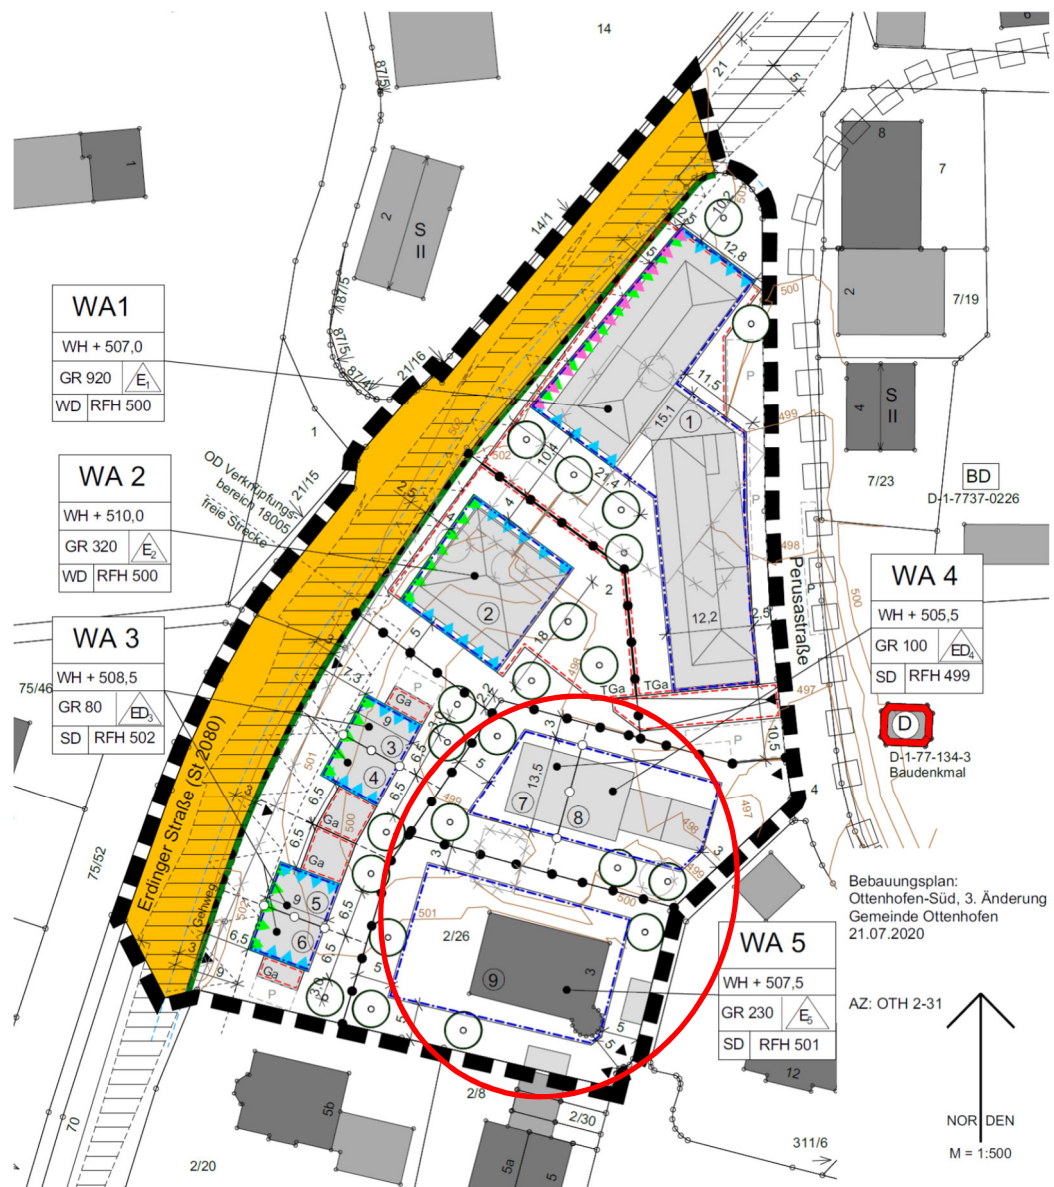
Bebauungsplan „Ottenhofen Süd“ 3. Änderung, in der Fassung vom 21.07.2020, Planzeichnung, ohne Maßstab
